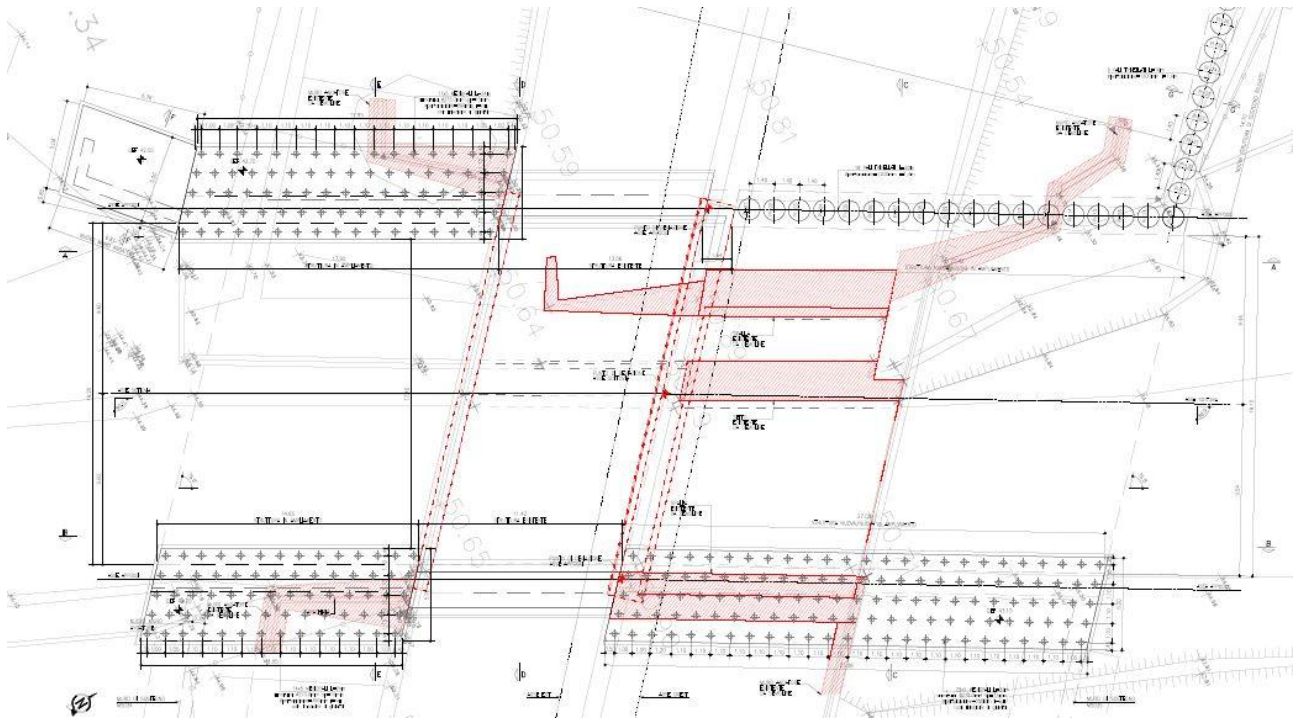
Planimetria di progetto opere di fondazione.
